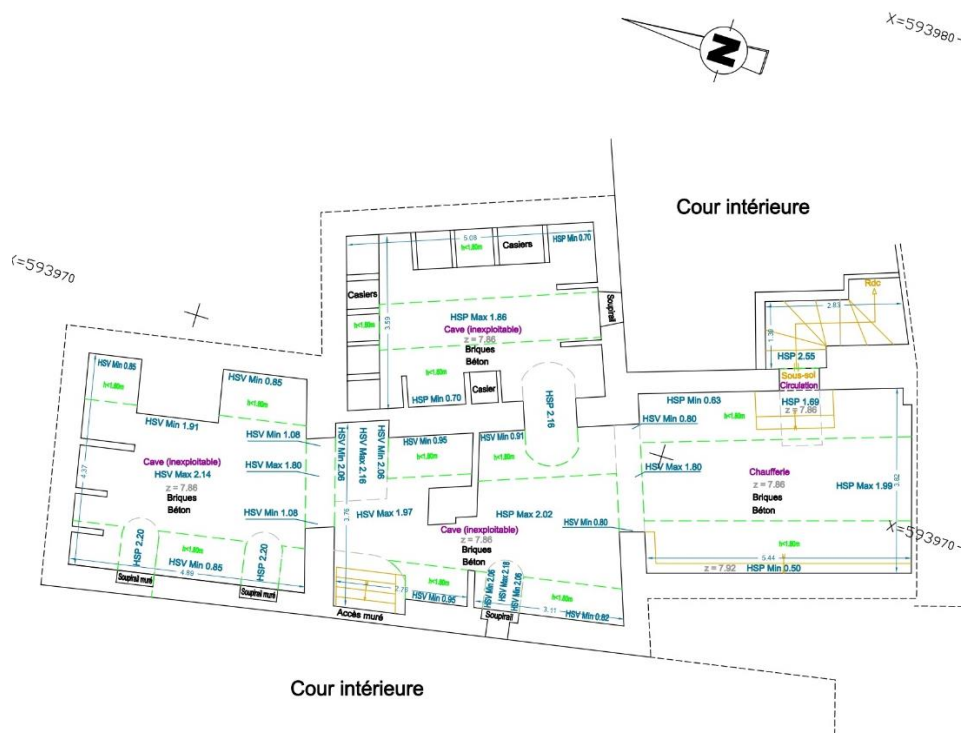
Plan de masse du sous-sol du bâtiment mitoyen existant (Source : Ministère de la Justice)
